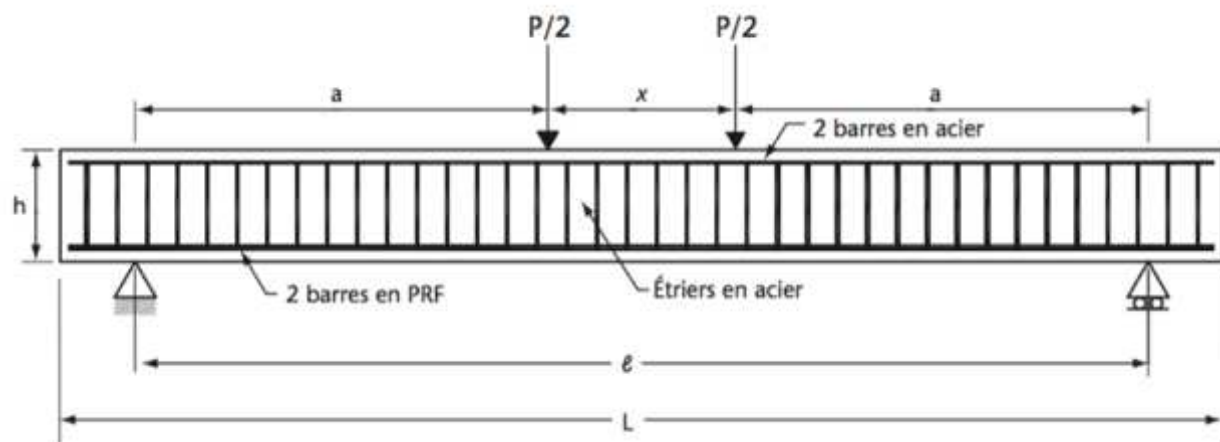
Dimensions recommandées d'une poutre selon la norme CSA S806-12
